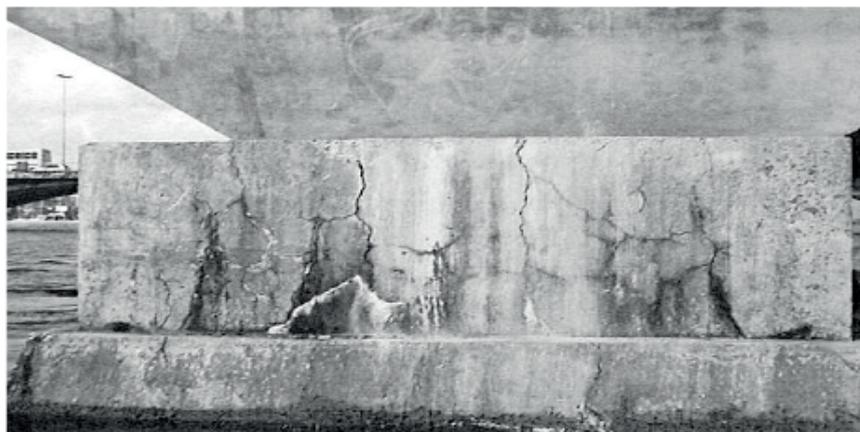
Bloco de fundação com intensa fissuração e lixiviação induzida por RAA.
